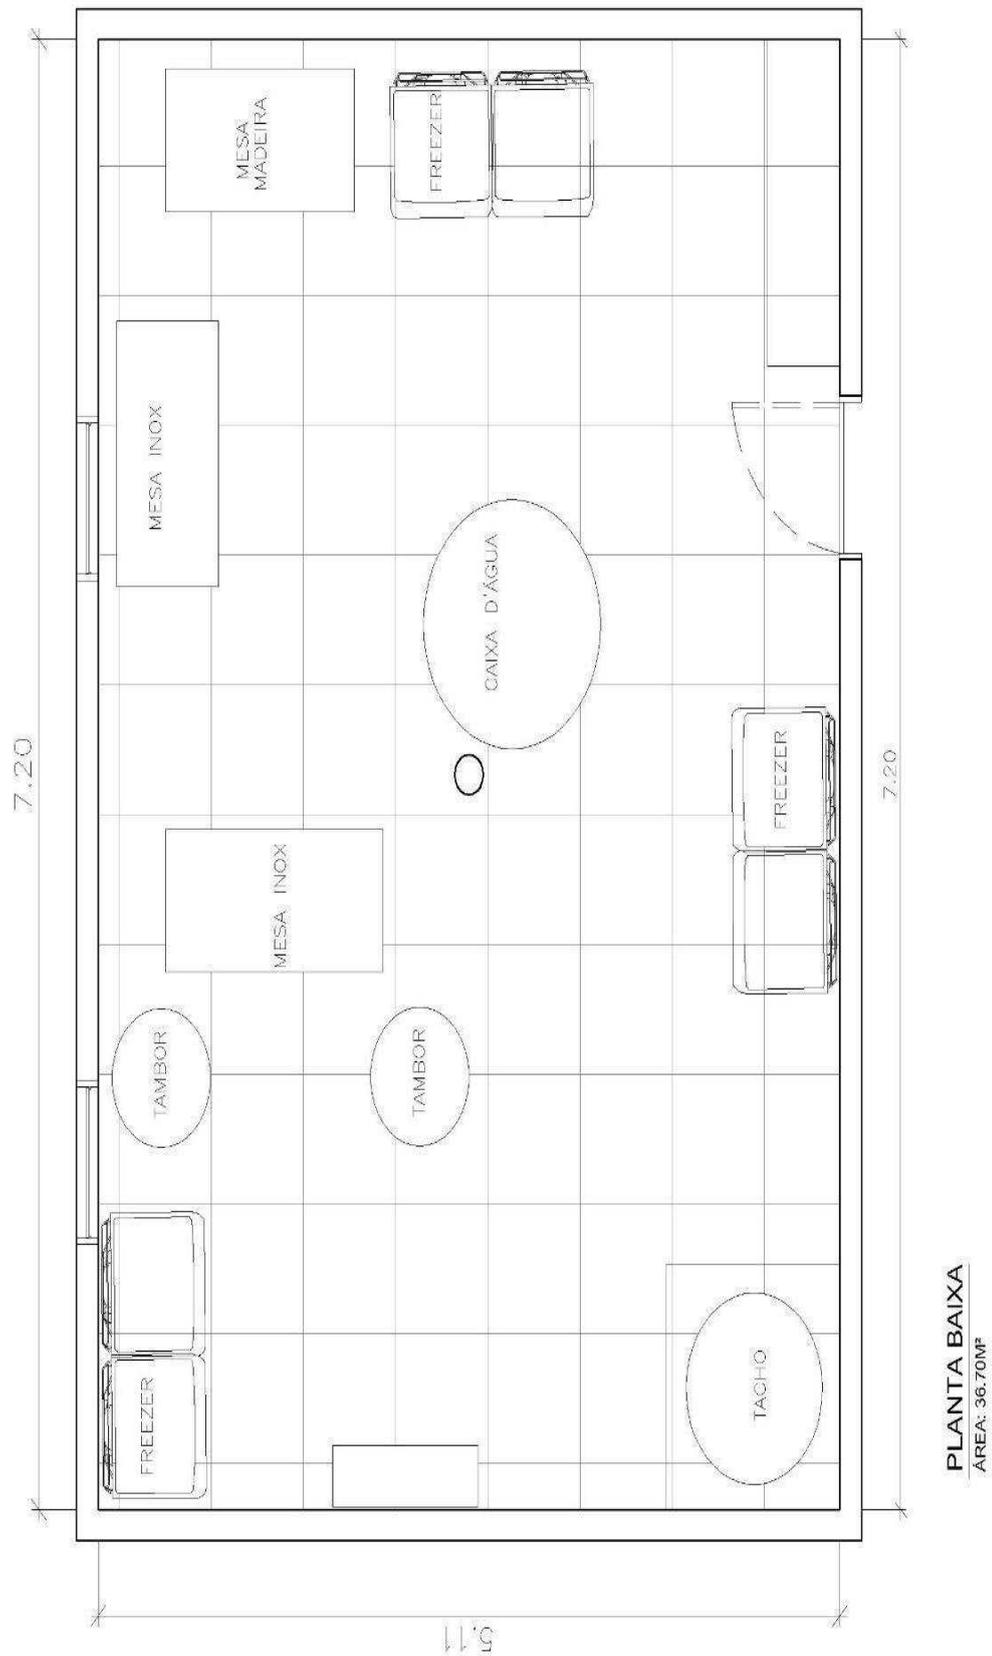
Planta baixa da Queijaria J. Fonte: Autora, 2021.
